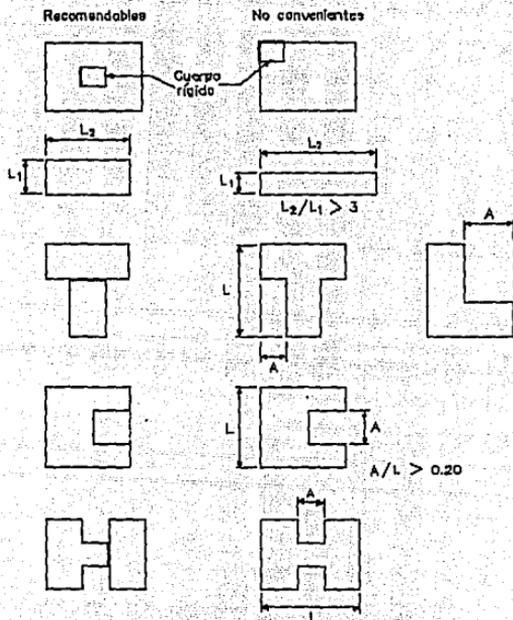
Recomendaciones sobre geometría de la planta de las estructuras para edificios.
